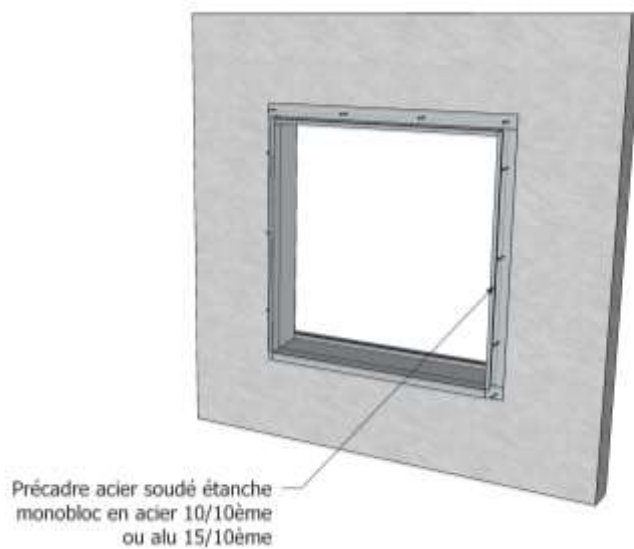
Pose et fixation du précadre soudé étanche monobloc
